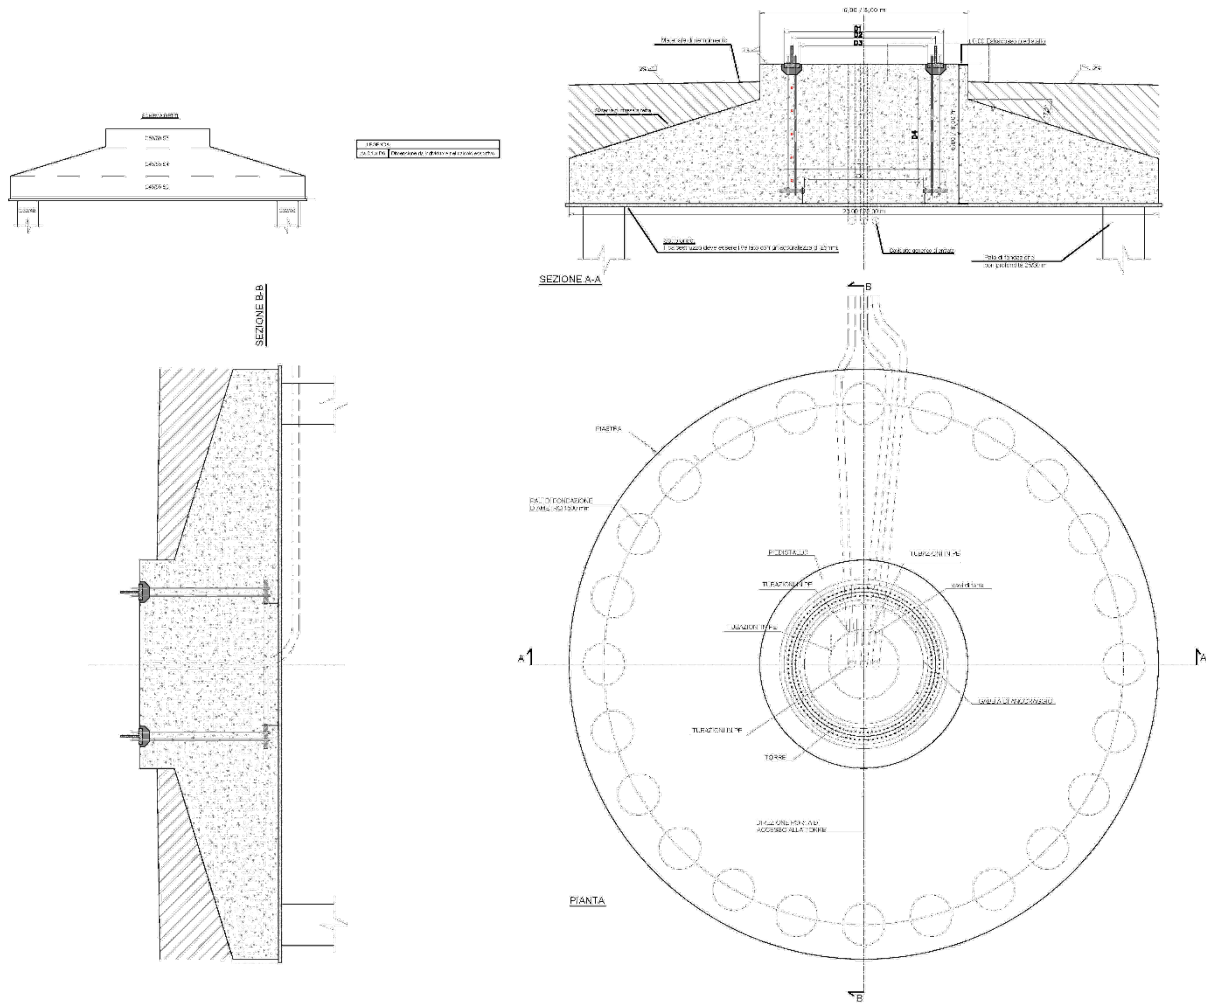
Rif. Elaborato F.2 - schema rappresentativo della fondazione tipo
